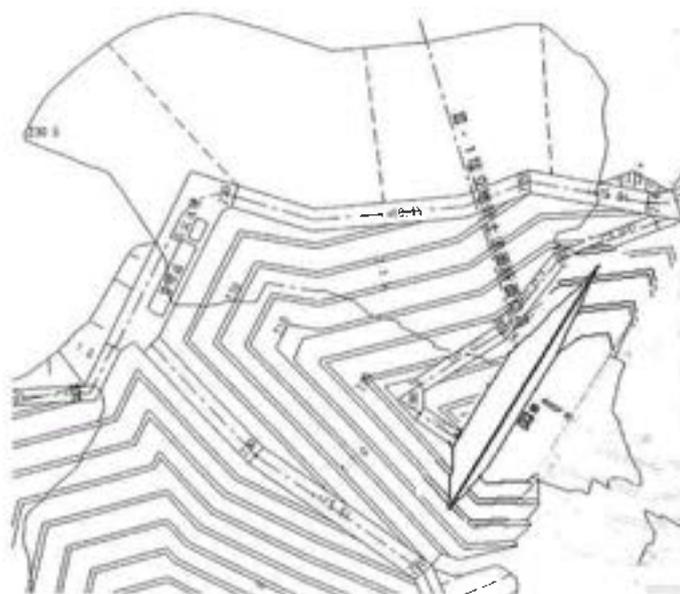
安定計算断面位置図(Ⅲ-1埋立地盛土法面)
